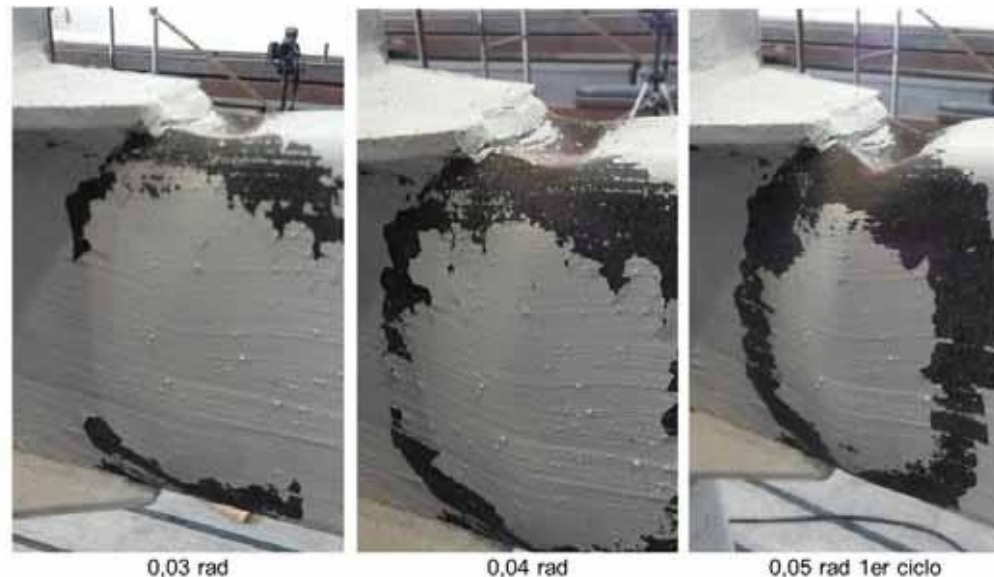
Pandeo local de los elementos de la secciones del miembro tipo viga del ensayo #3
